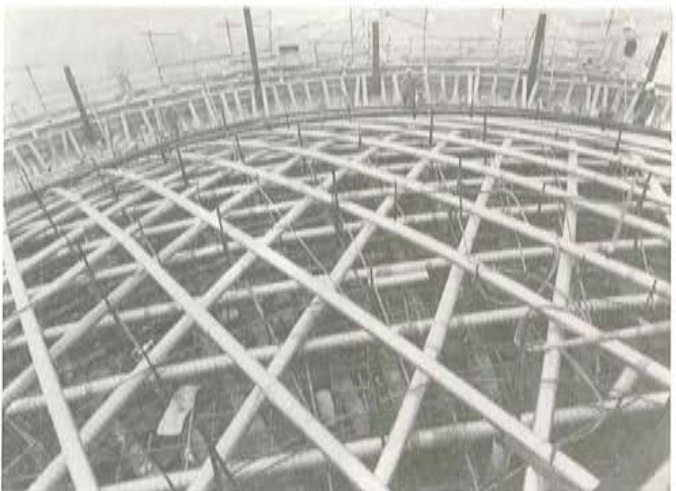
Edificio de Contención-Armadura viga anillo y capa inferior de la cúpula.
